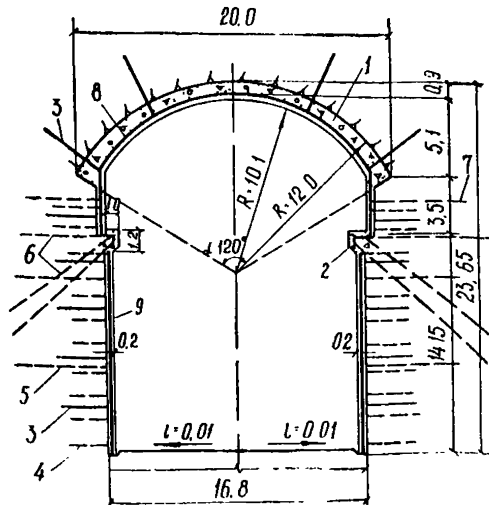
Слабоармированная бетонная обделка стен выработки, прианкеренная к грунту:
